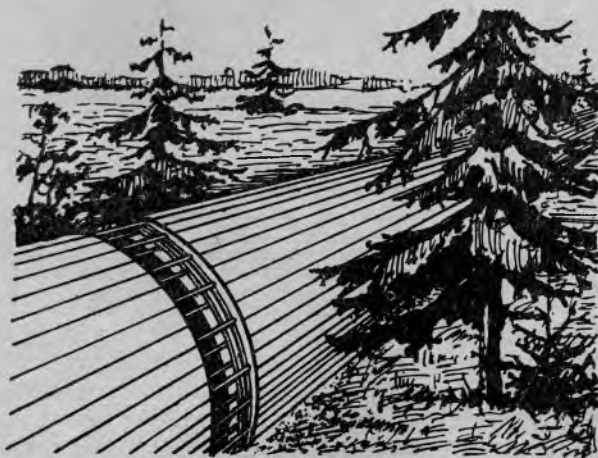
Температурно-усадочный шов на монолитном железобетонном трубопроводе.
